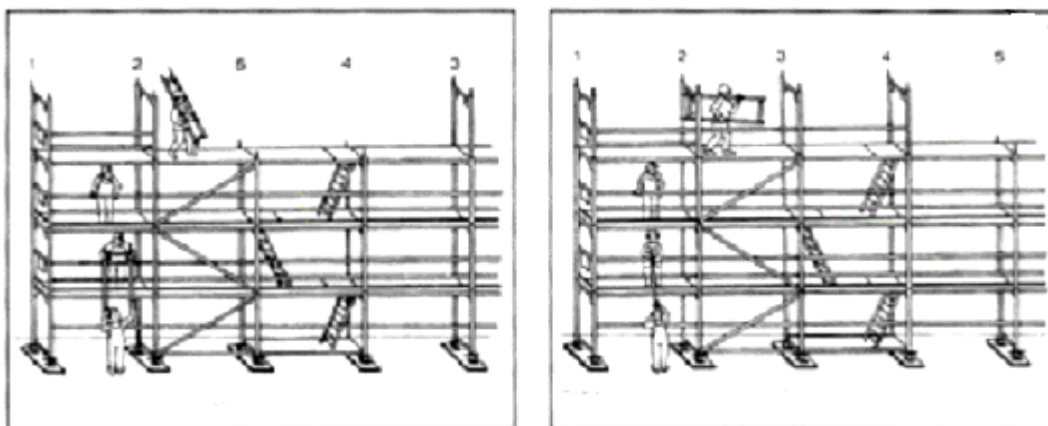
Montaggio e smontaggio con sollevamento manuale degli elementi
